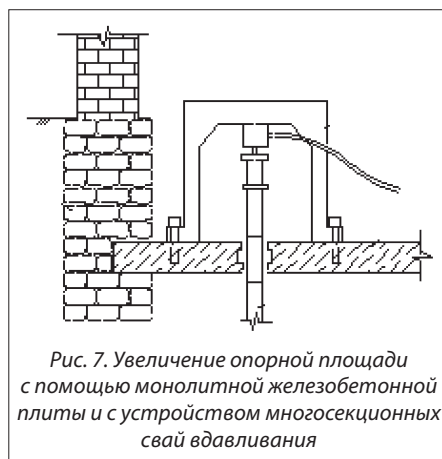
Увеличение опорной площади с помощью монолитной железобетонной плиты и с устройством многосекционных свай вдавливания
